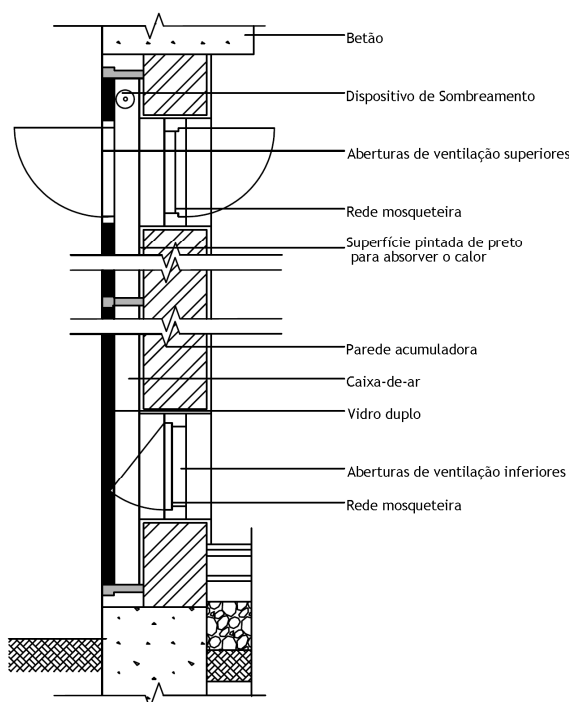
Pormenor construtivo da parede de Trombe [41].
